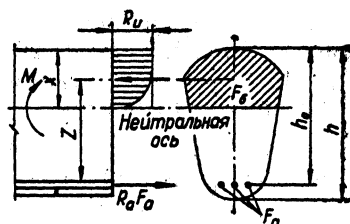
Сечение с одиночной арматурой, симметричное относительно вертикальной оси.
